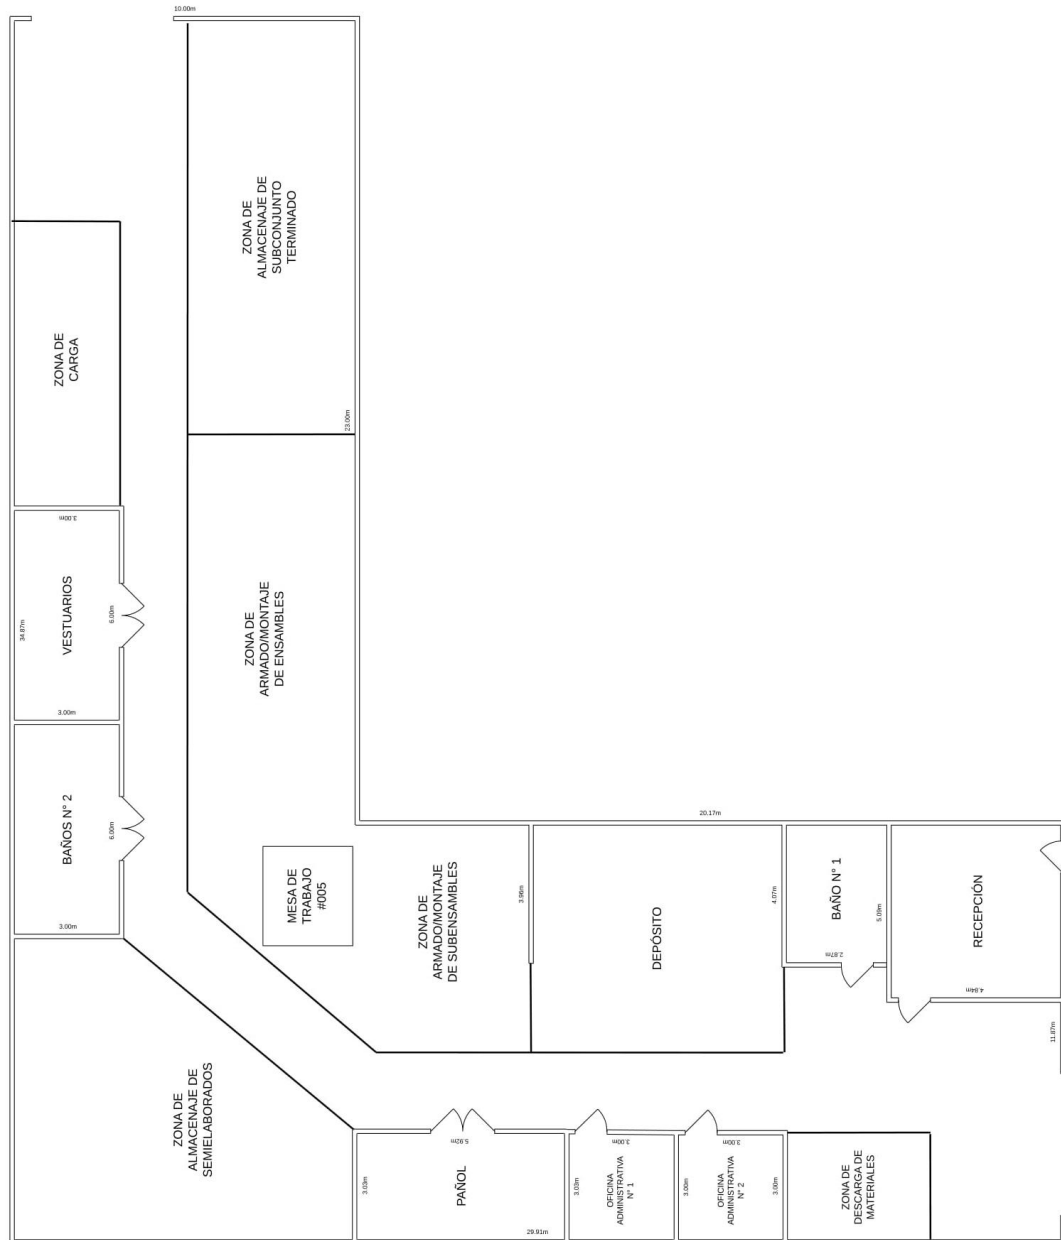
Lay Out de planta de Taller Bobinados Mario SH. Elaborado por los autores.
